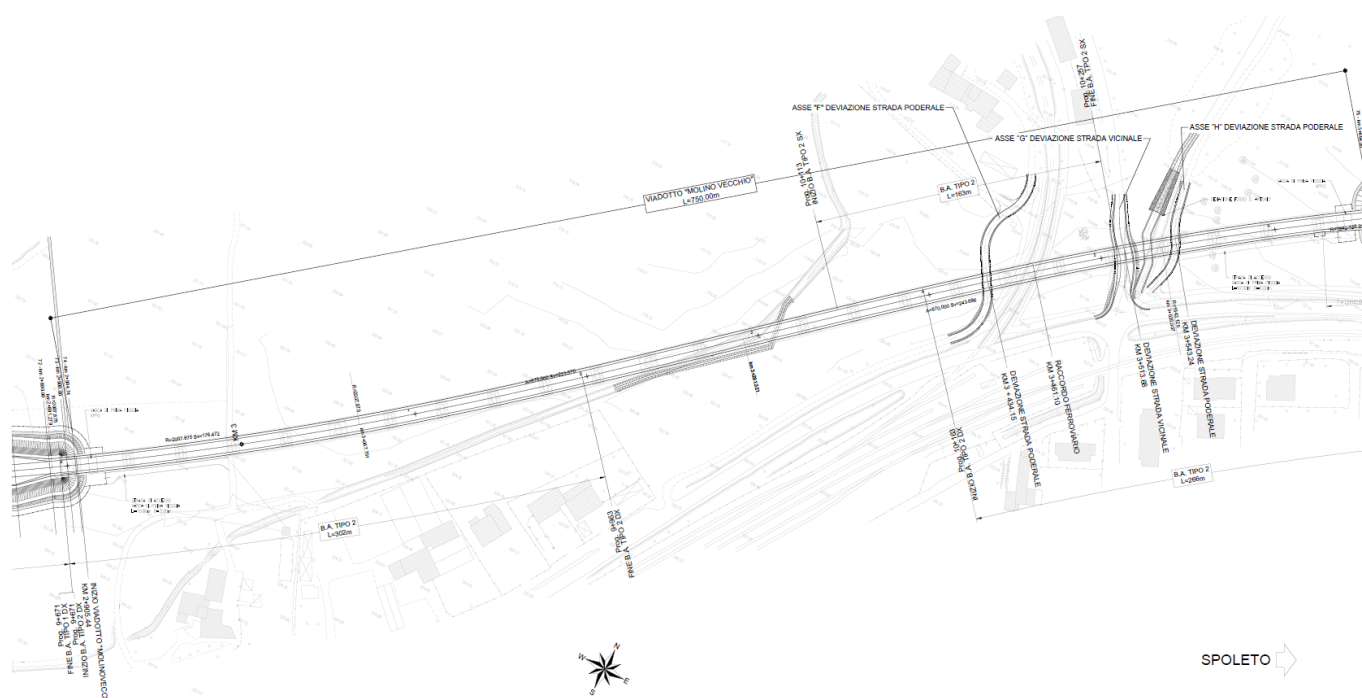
Stralcio planimetrico del Viadotto Molino Vecchio.
